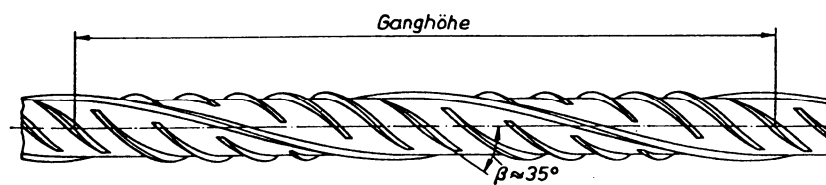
Kalt verwundener Betonstahl BSt 420 S
